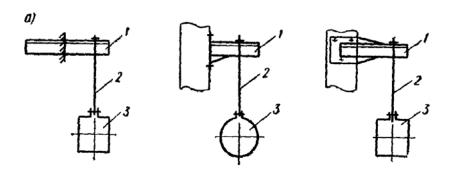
8. Схемы крепления воздуховодов к стенам и колоннам: I – кронштейн; 2 – тяга; 3 – хомут
